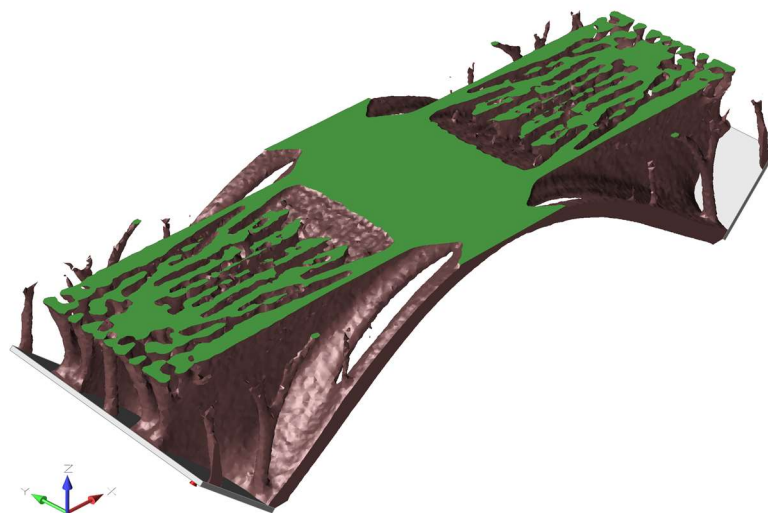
3D-Brücke horizontaler Schnitt -0,1 m
